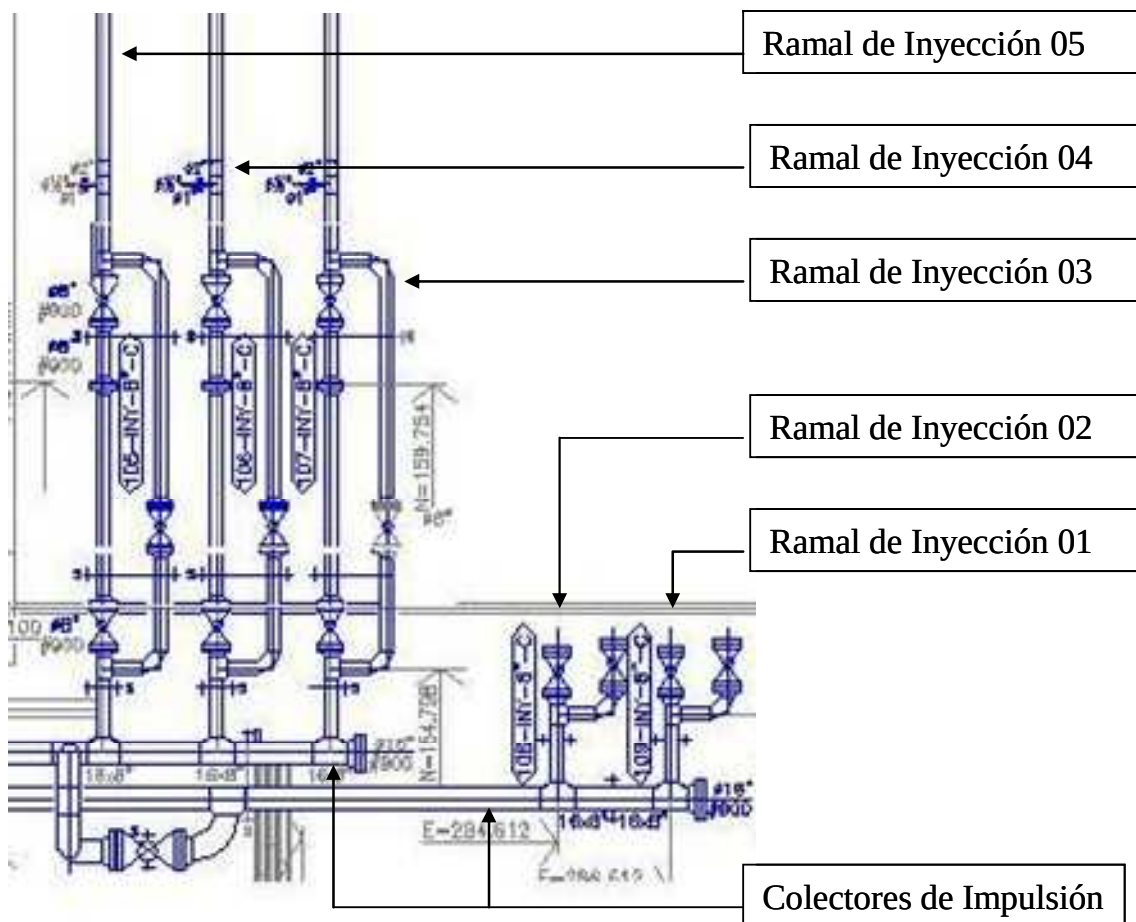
Esquema de Ramales de Inyección. Salida de Planta.
